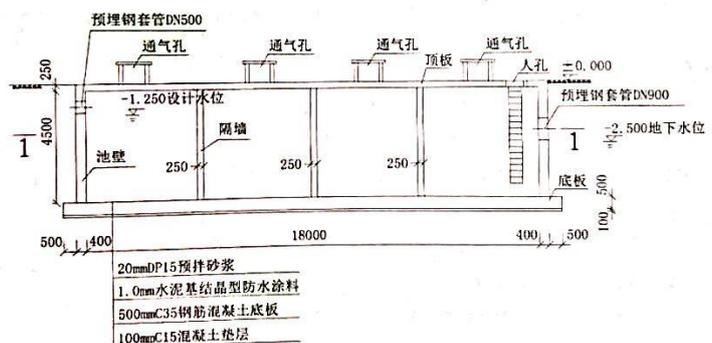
水池剖面图 (标高单位: m; 尺寸单位: mm)
